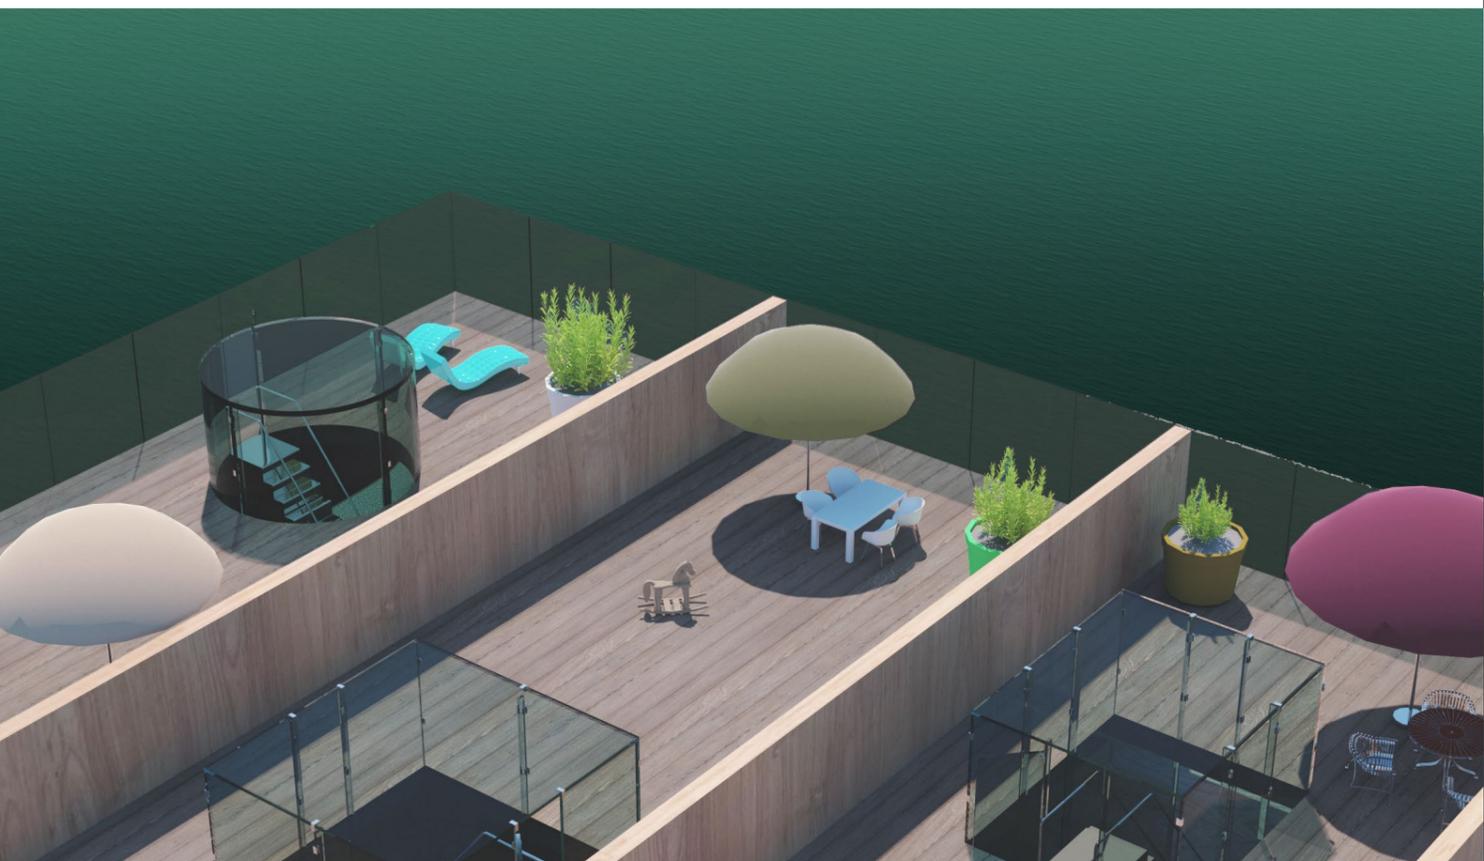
Vista aérea cercana, sobre el solarium de las viviendas
